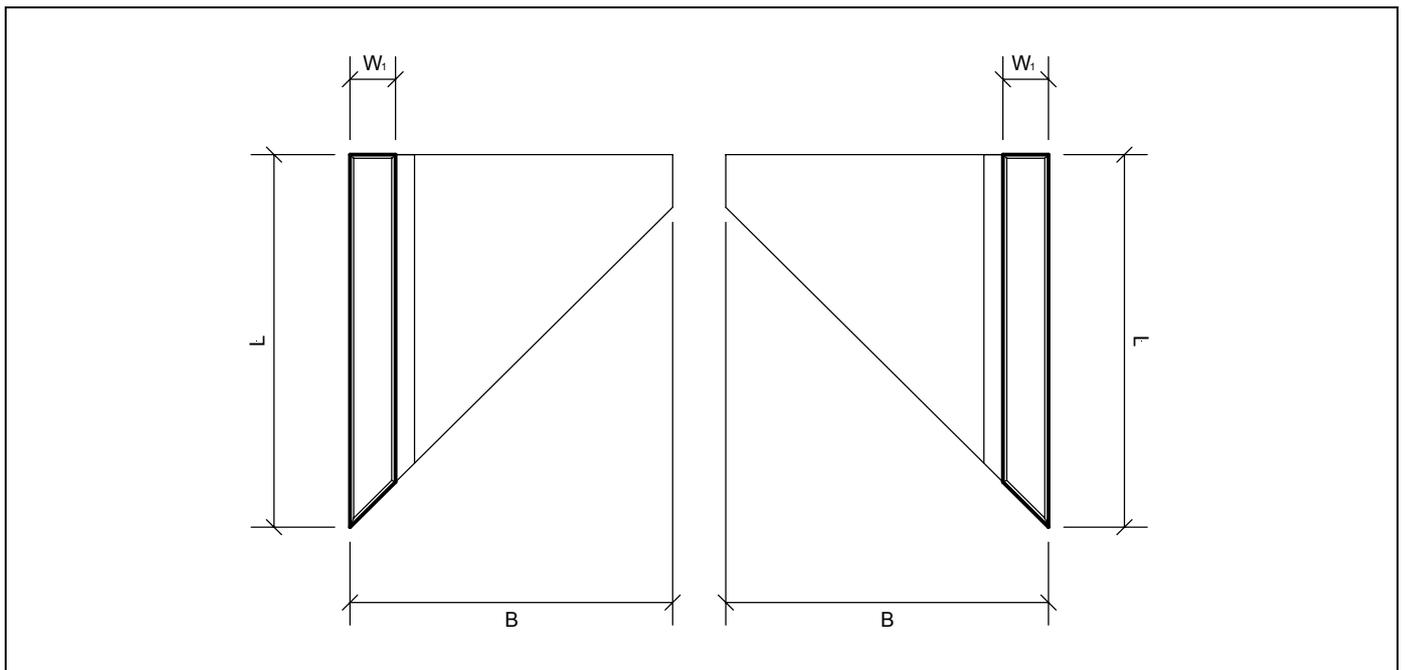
Grundrisse Eckstücke links und rechts
